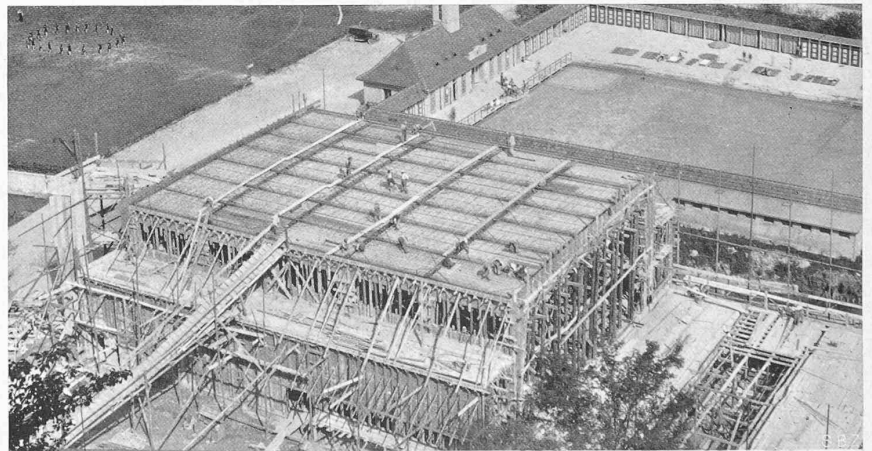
Betonieren des Daches der nördlichen Hallenhälfte, vom Schloss aus gesehen.
